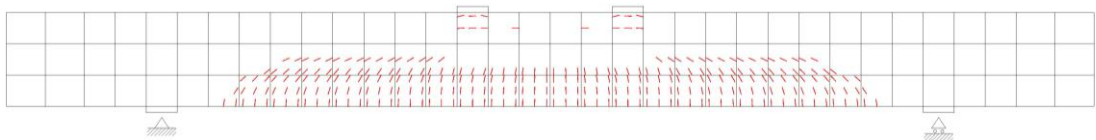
破壊時の変形及びひび割れ状態 (Case No. 8)
